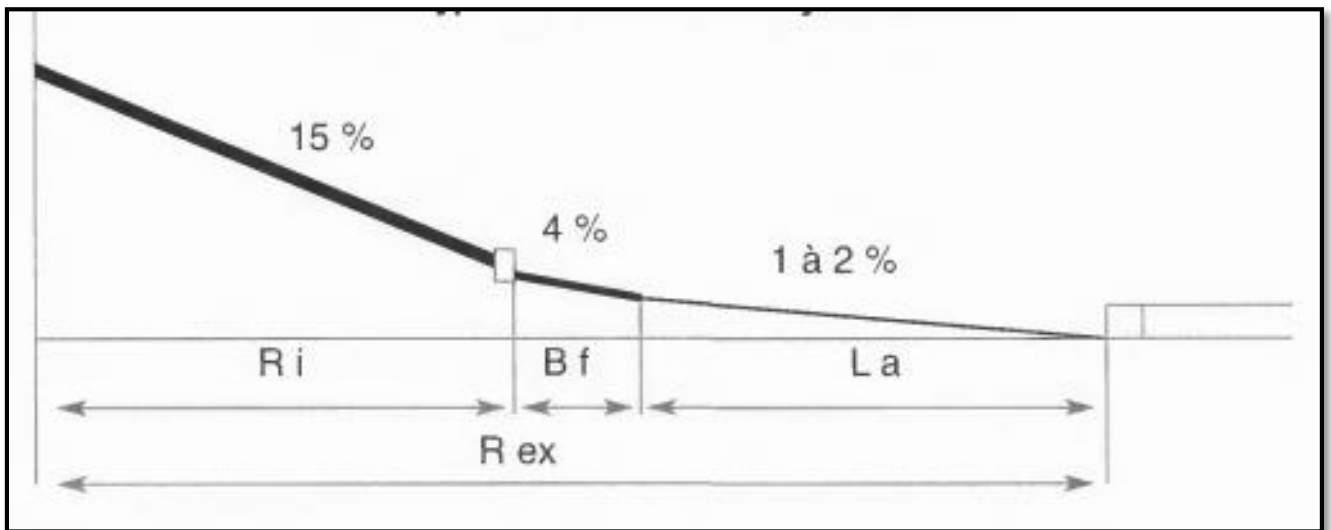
Différentes pentes de l'anneau et l'îlot central
